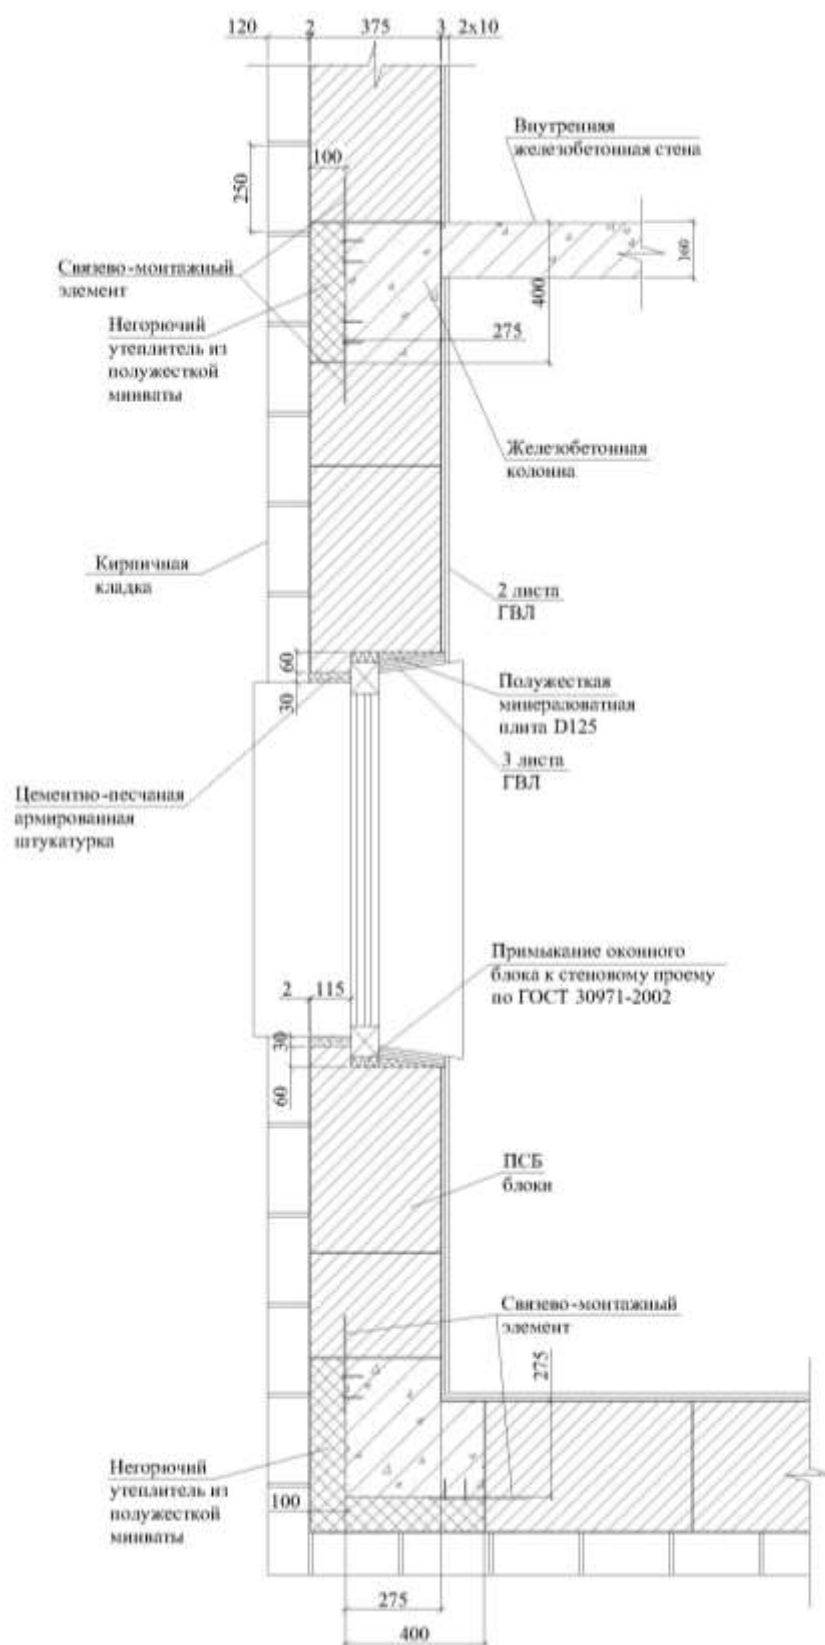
Ненесущая стена из ПСБ блоков с несущими железобетонными колоннами и кирпичной облицовкой фасада. Горизонтальный разрез
